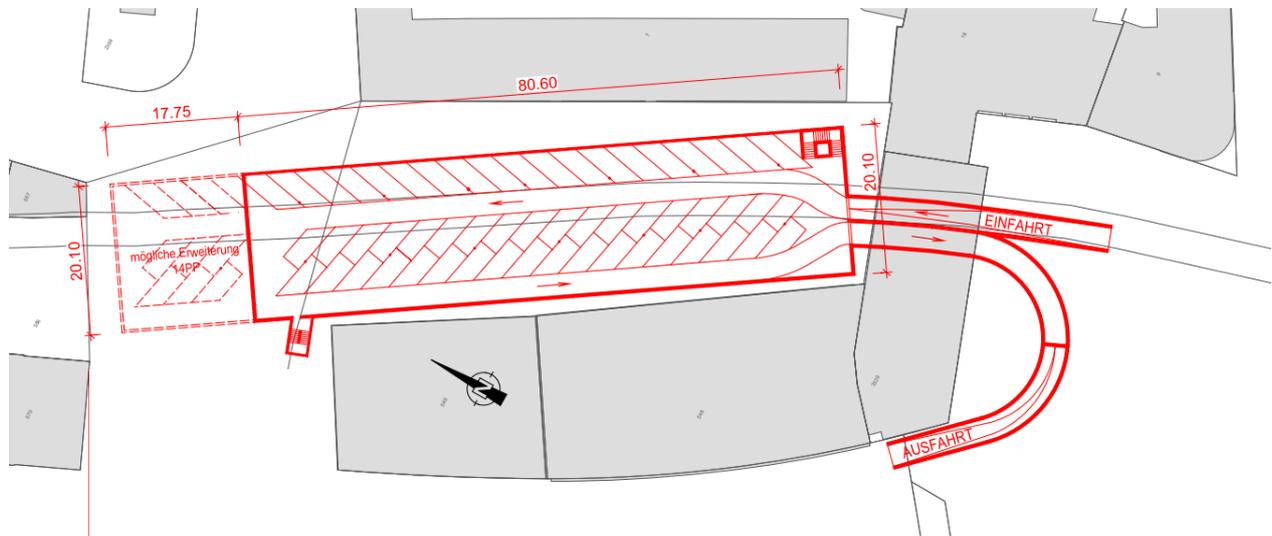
Ausschnitt Situation Variante Obergrund 2 Grundriss Parkgeschoss
